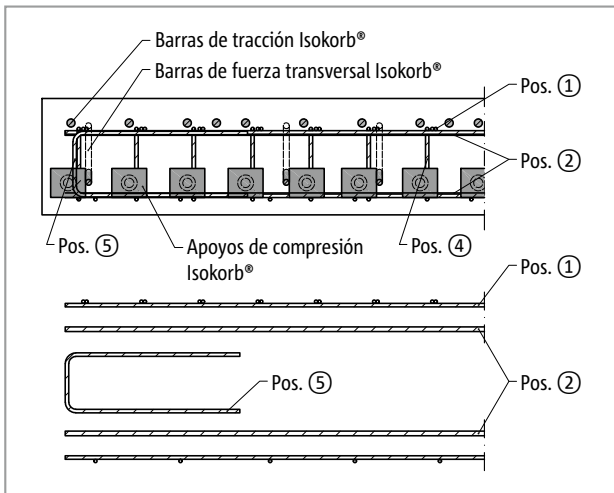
Schöck Isokorb® T tipo K-M12: Armadura in situ del lado del balcón en la sección A-A; pos.5 = con refuerzo constructivo en el borde libre perpendicular al Schöck Isokorb®
